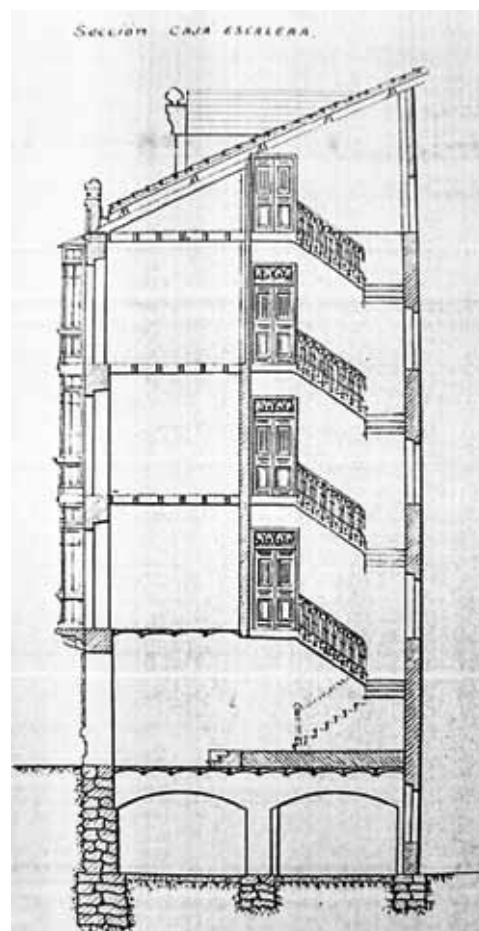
Sección transversal en la que pueden apreciarse la cimentación, el espesor de los muros maestros y la combinación de entramados metálicos y de madera. Maestro de obras Benigno Rodríguez.
